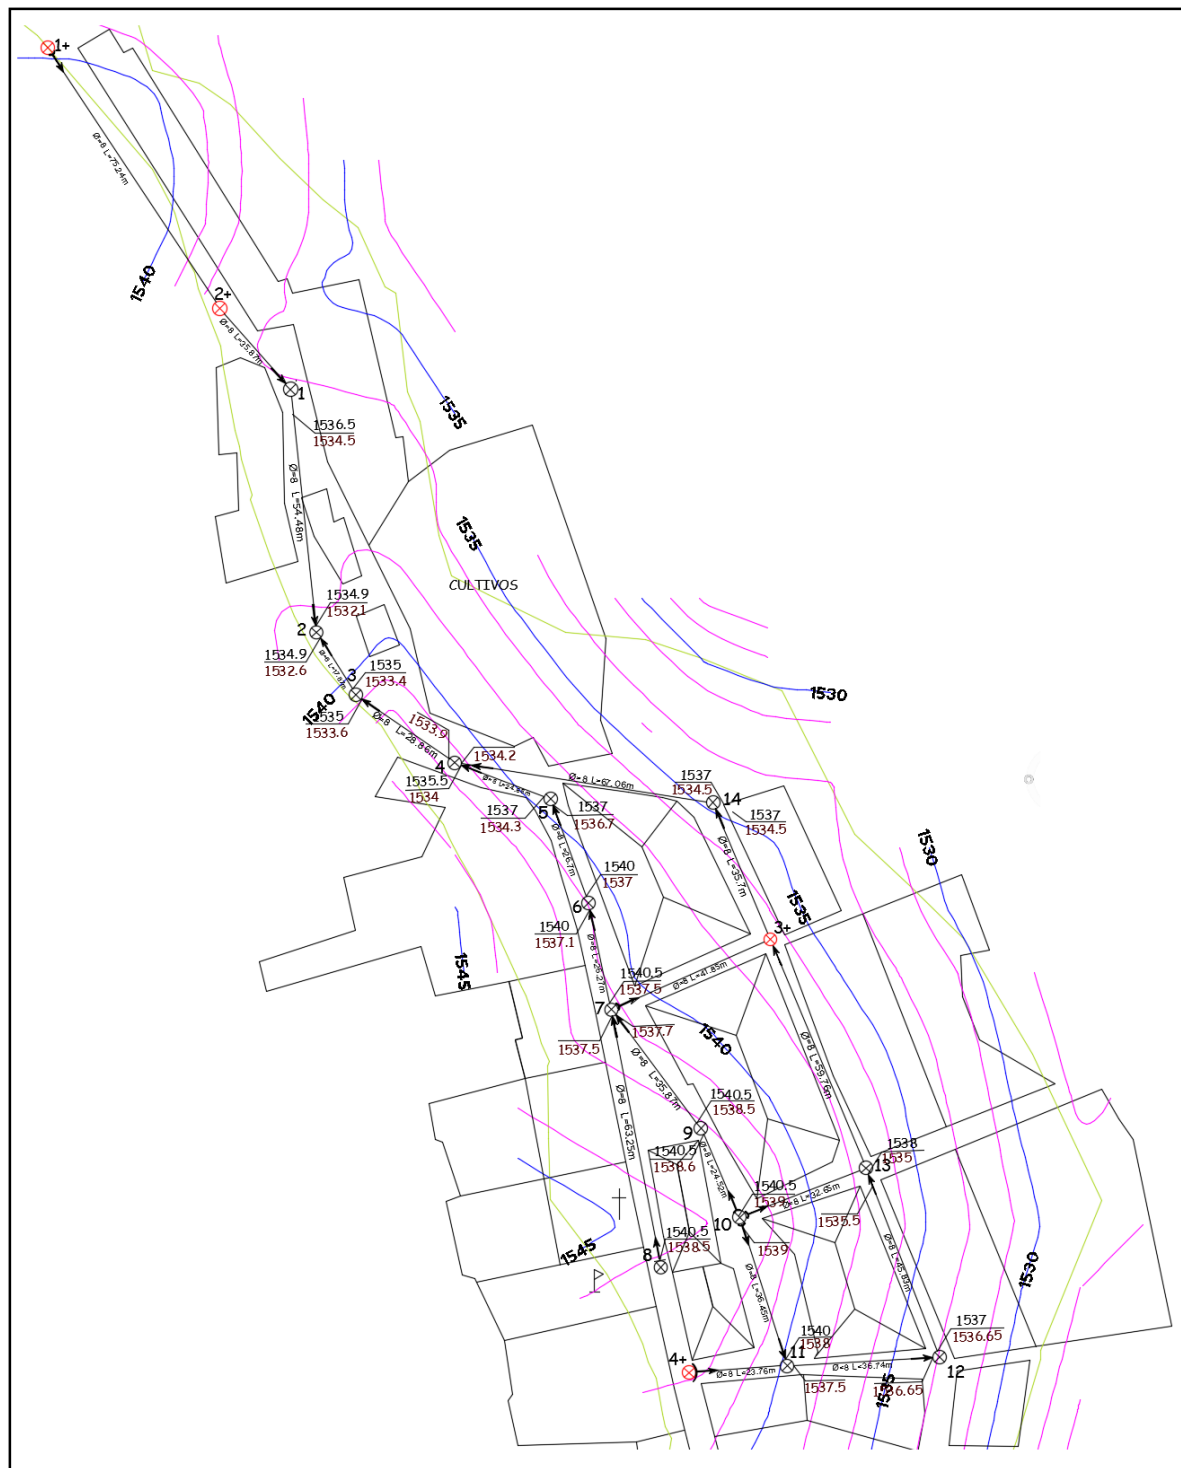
Plano en planta del alcantarillado viejo proyectado.
